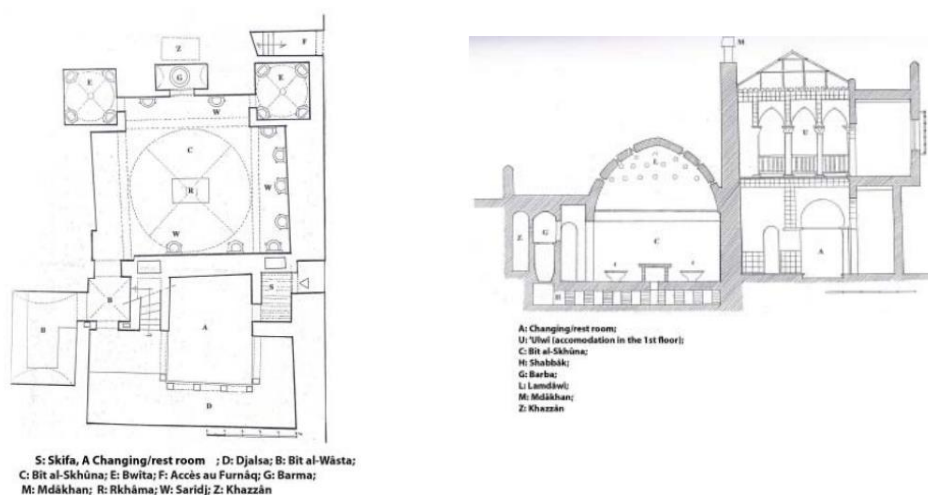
plan et coupe du Hammam Sirk djiAlger.
